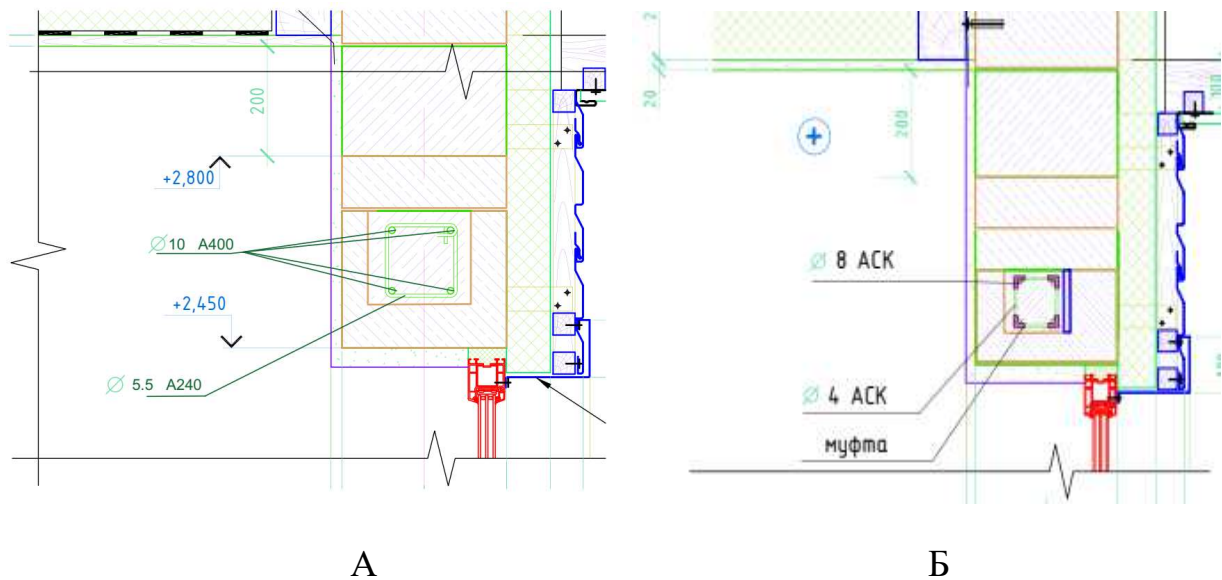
Армопояс: А- сталюї арматура; Б – композитна арматура
